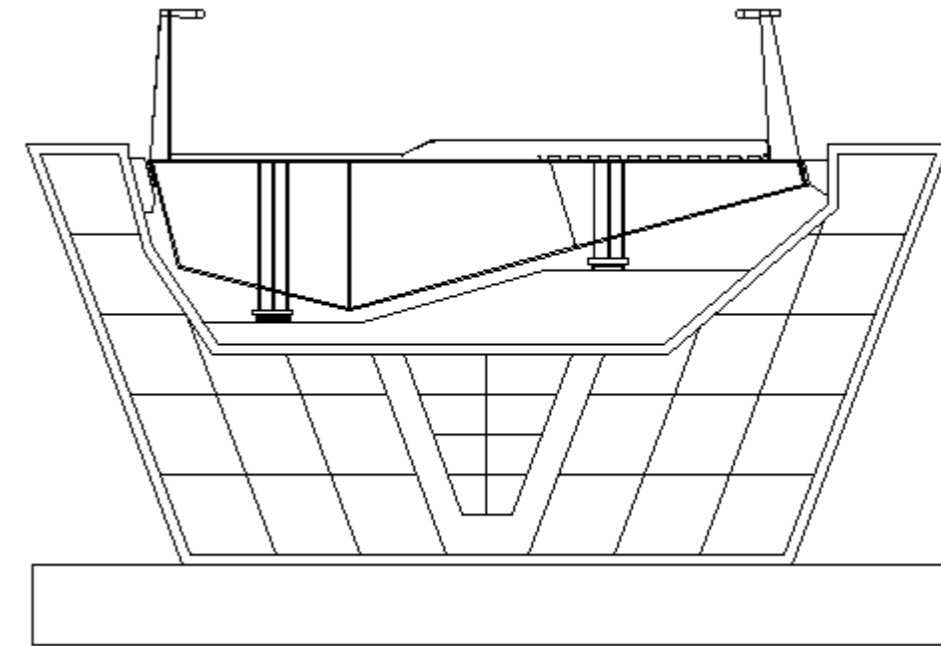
Diseño final del estribo con el tablero y neoprenos (alzado). Fuente: Elaboración propia.
